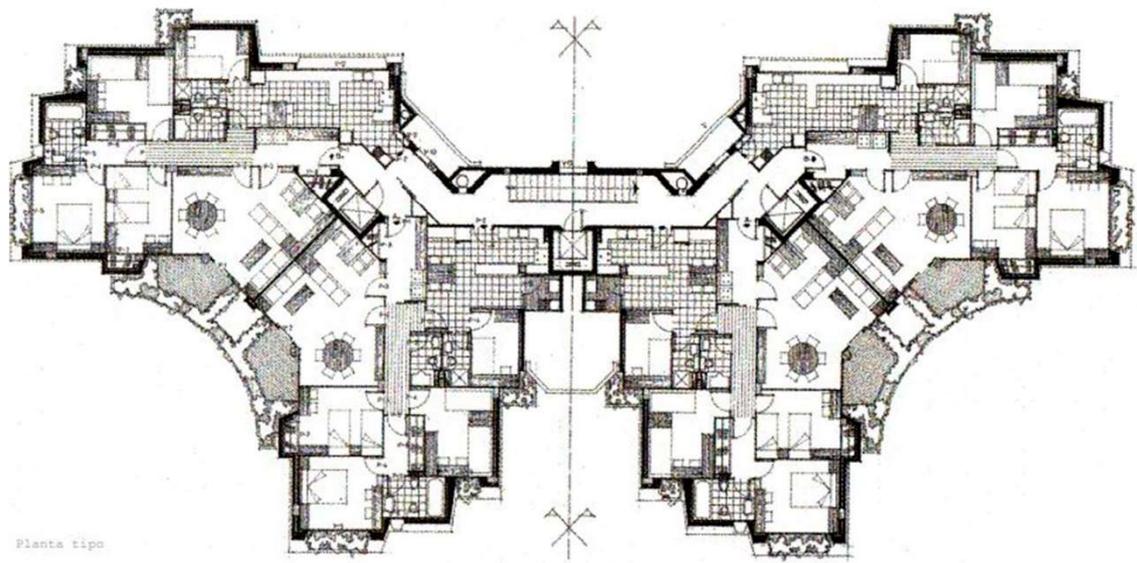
y 58: Fotocopia planos originales del proyecto.
